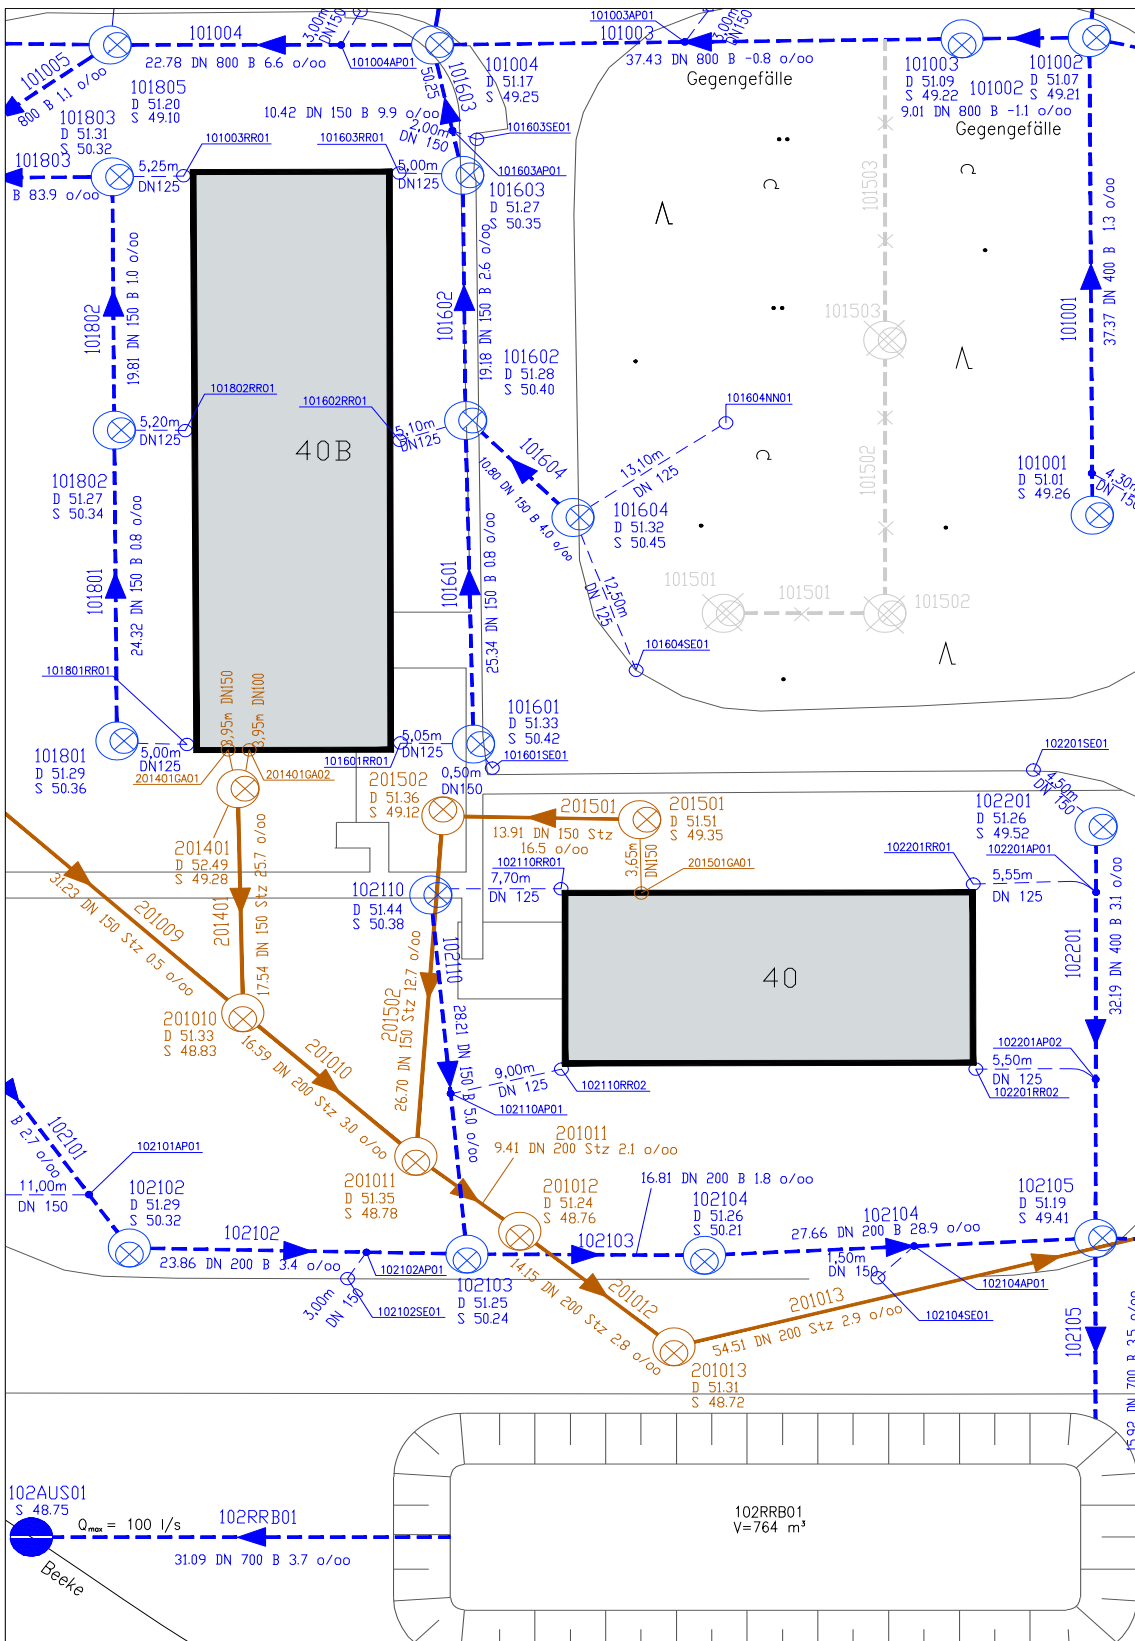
Beispielplan: Lageplan „Bestand Abwasser“
